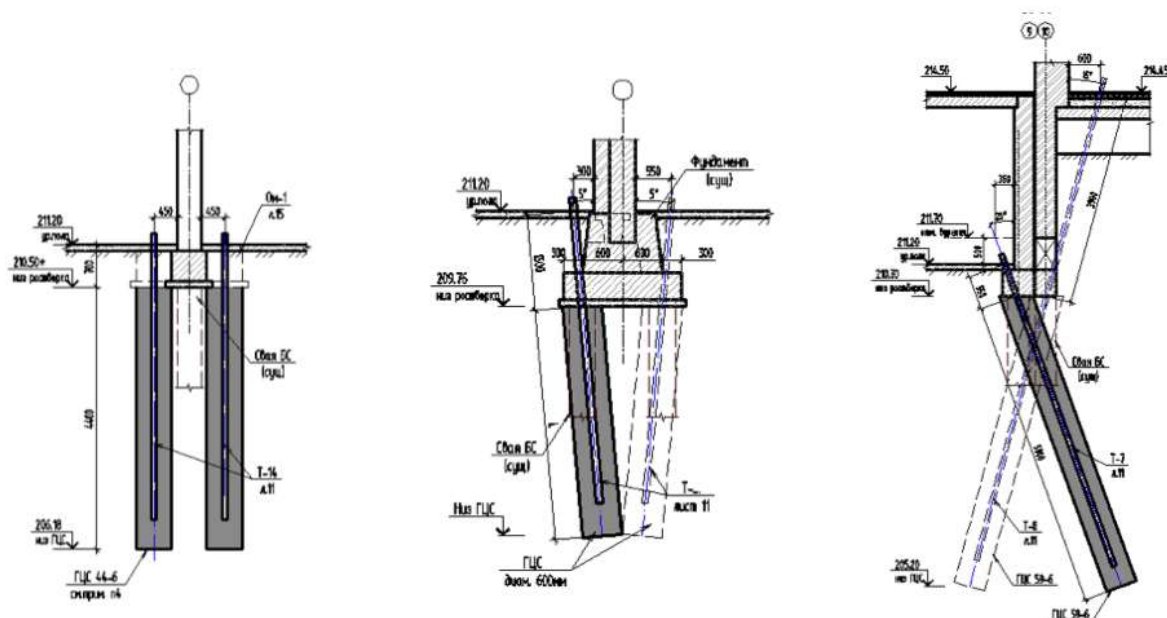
Конструкция усиления существующих фундаментов грунтобетонными элементами
